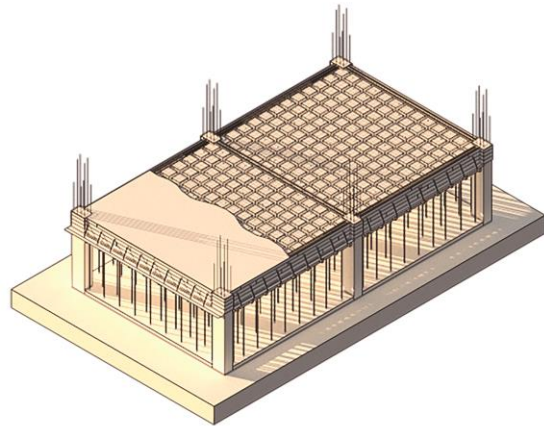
Columnas- zapatas y vigas de cimentación. Figura 43- Losas aligeradas y vigas descolgadas sin volados.
